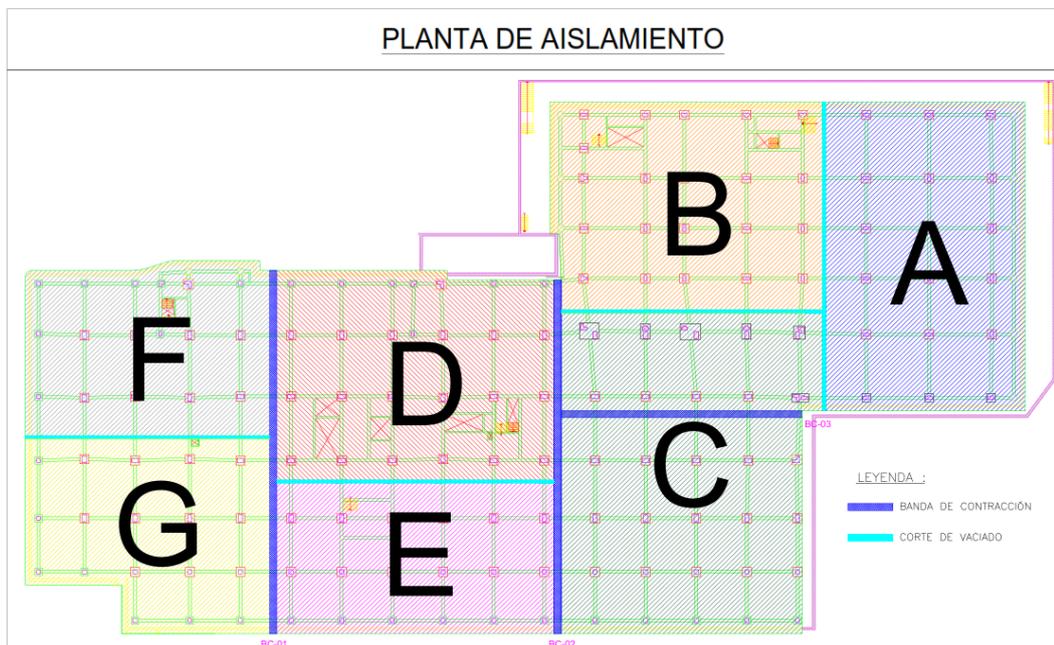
Sectorización para la Planta de Aislamiento (Fuente: Consorcio Salud Tacna)
